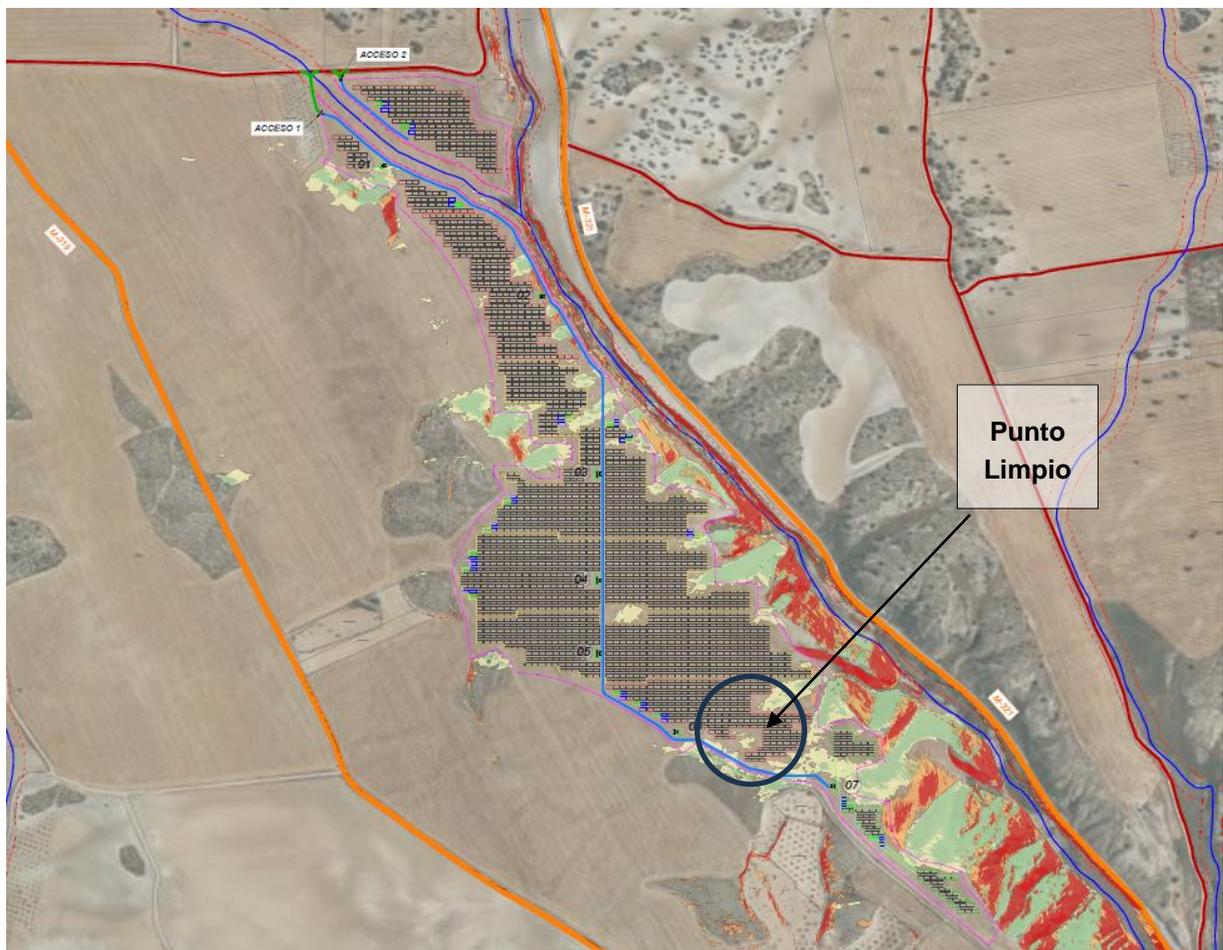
Situación de punto limpio en la planta fotovoltaica.
